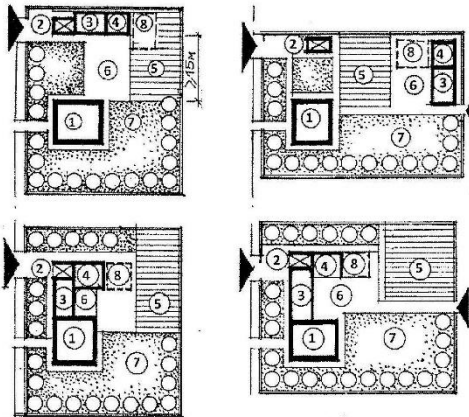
Варианты планировки участка усадебного жилого дома:
